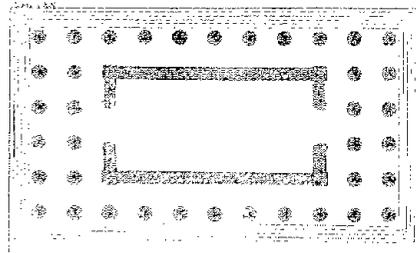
Planta con columnata de Vitruvio según Perrault.
